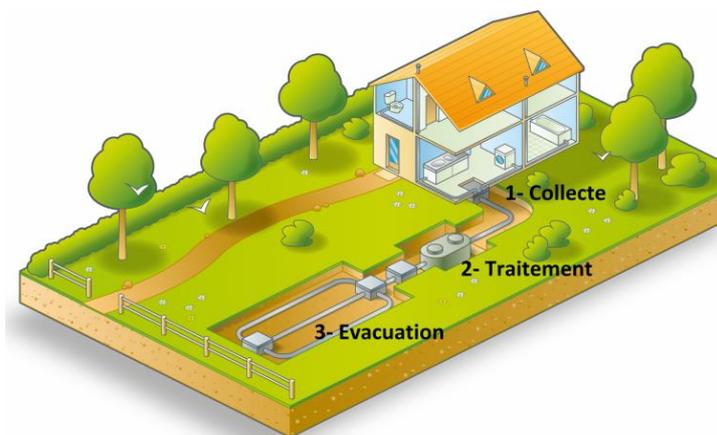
Exemple d'un système d'assainissement non collectif (Source : <https://cc-ossau.fr/assainissement/#> , janvier 2024)
